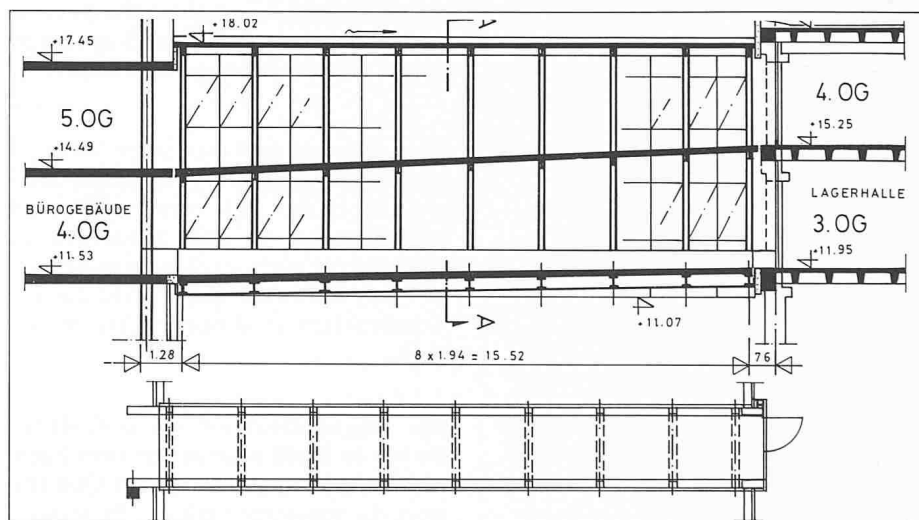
Längsschnitt und Grundriss der Passerelle
